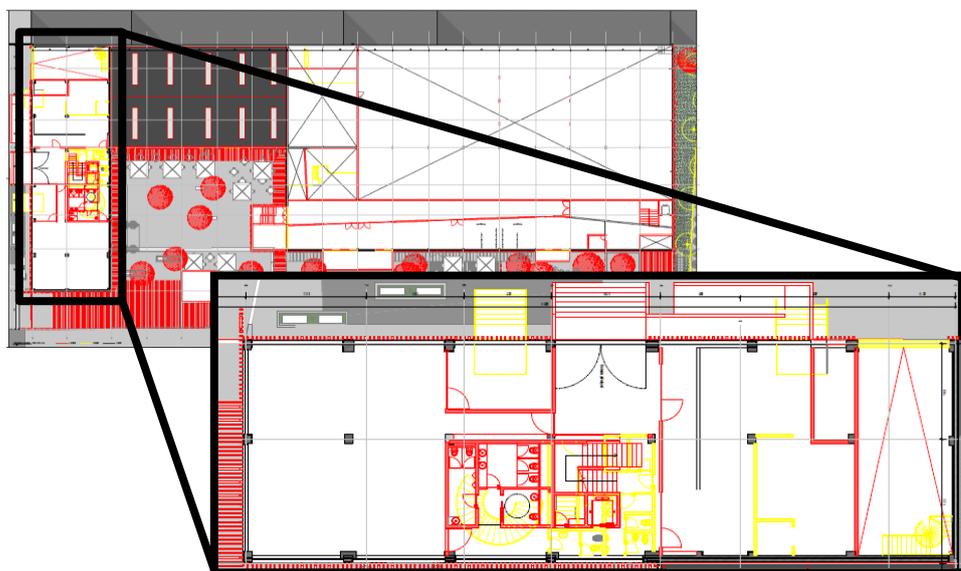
Planta do rés-do-chão do edifício 1 e a sua respetiva localização na Planta geral do piso 0 (amarelo - a demolir; vermelho - a construir)
